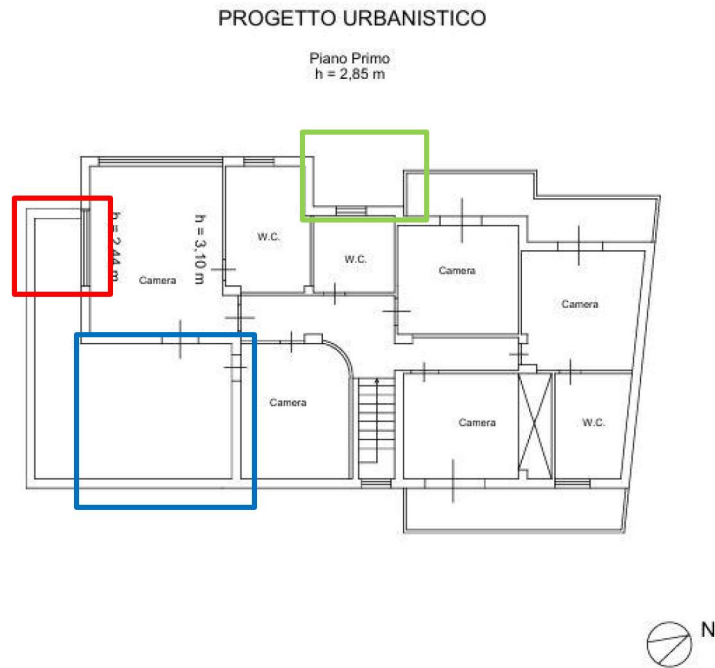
Planimetria Sub 7 Piano 1° Progetto Urbanistico
